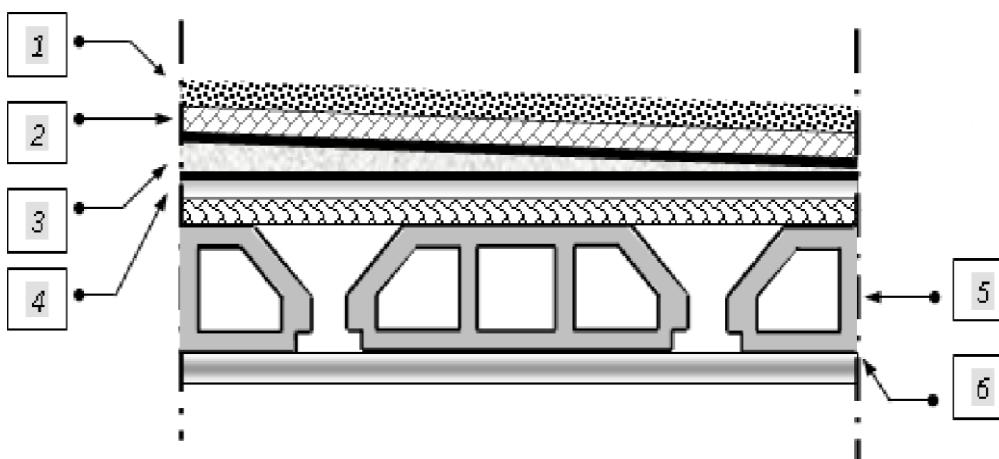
Coupe verticale du plancher terrasse à corps creux.
